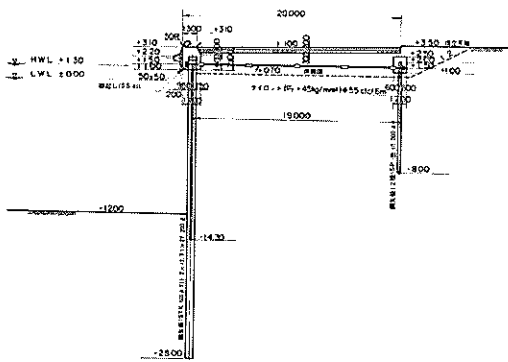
仙台港中野ふ頭1号(-12m)標準断面図
